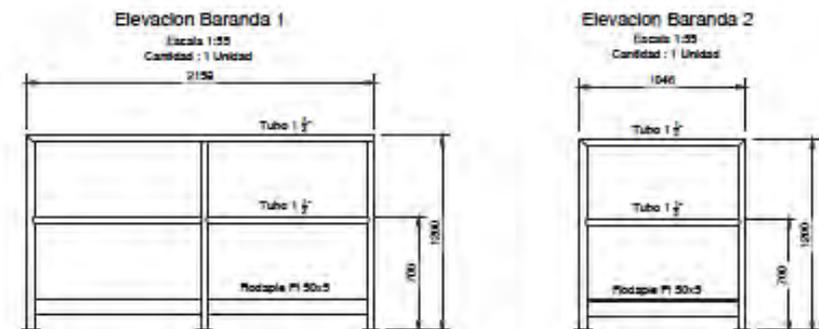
Elevación de Baranda 1 y 2 de Escalera. Fuente: Planimetría Ecova
